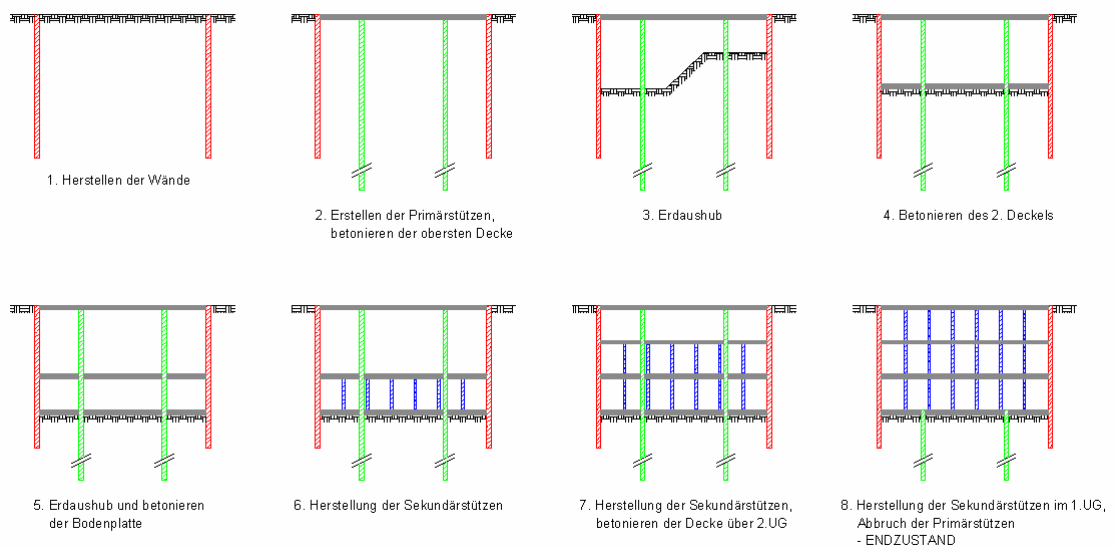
Darstellung der Errichtung einer Tiefgarage in Deckelbauweise als Bauphasenplan, Quelle: Lackinger 2010
